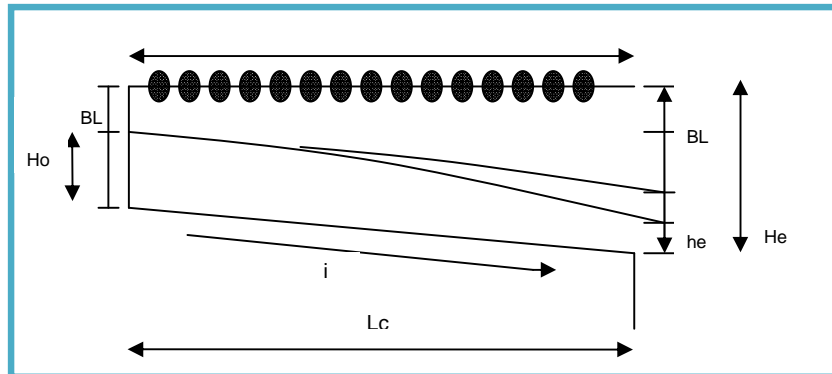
Perfil del canal de aducción (López Cualla)⁸
